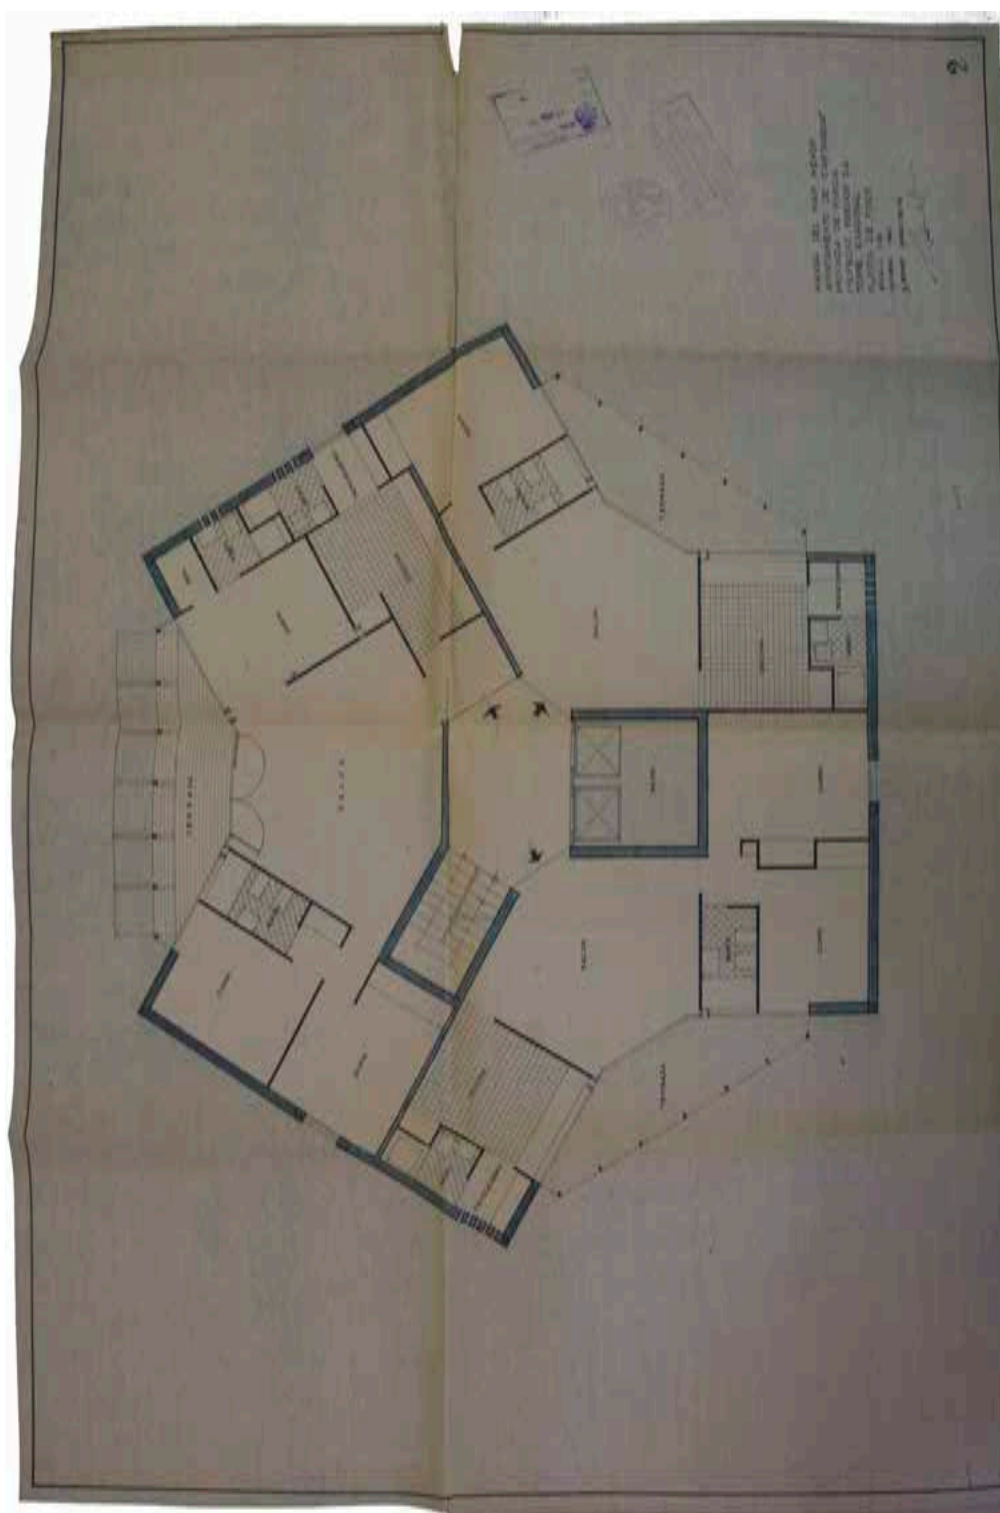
Planos del proyecto original de la Torre Hexagonal. Antonio Bonet Castellana. Plano de planta tipo. Escala original 1/50. Fecha octubre de 1963. Fuente: Archivo Municipal de Cartagena
